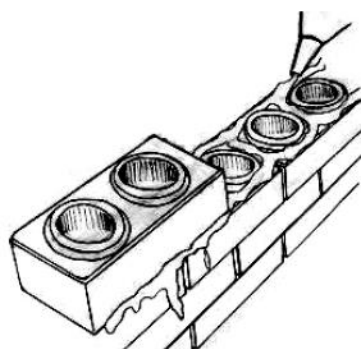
Assentamento dos tijolos com bisnaga preenchida por cola branca ou argamassa
